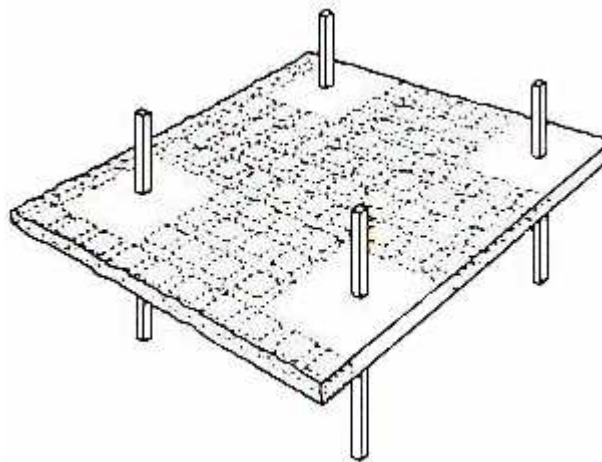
Forjado bidireccional transmitiendo las cargas a los pilares
